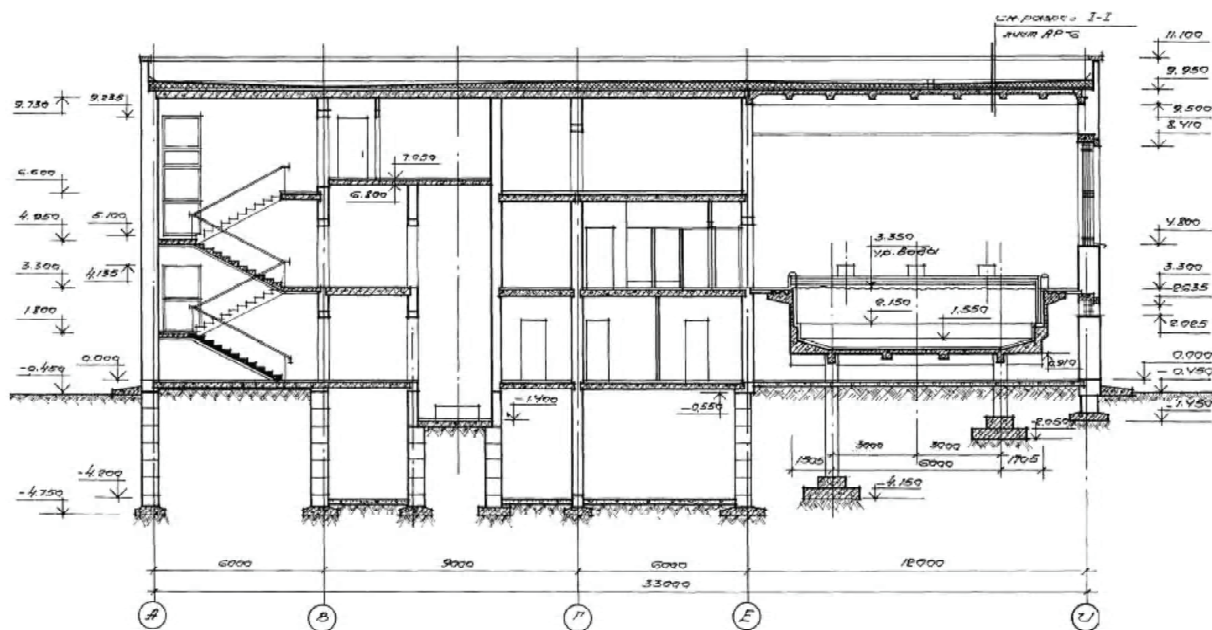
Поперечный разрез здания крытого бассейна.
